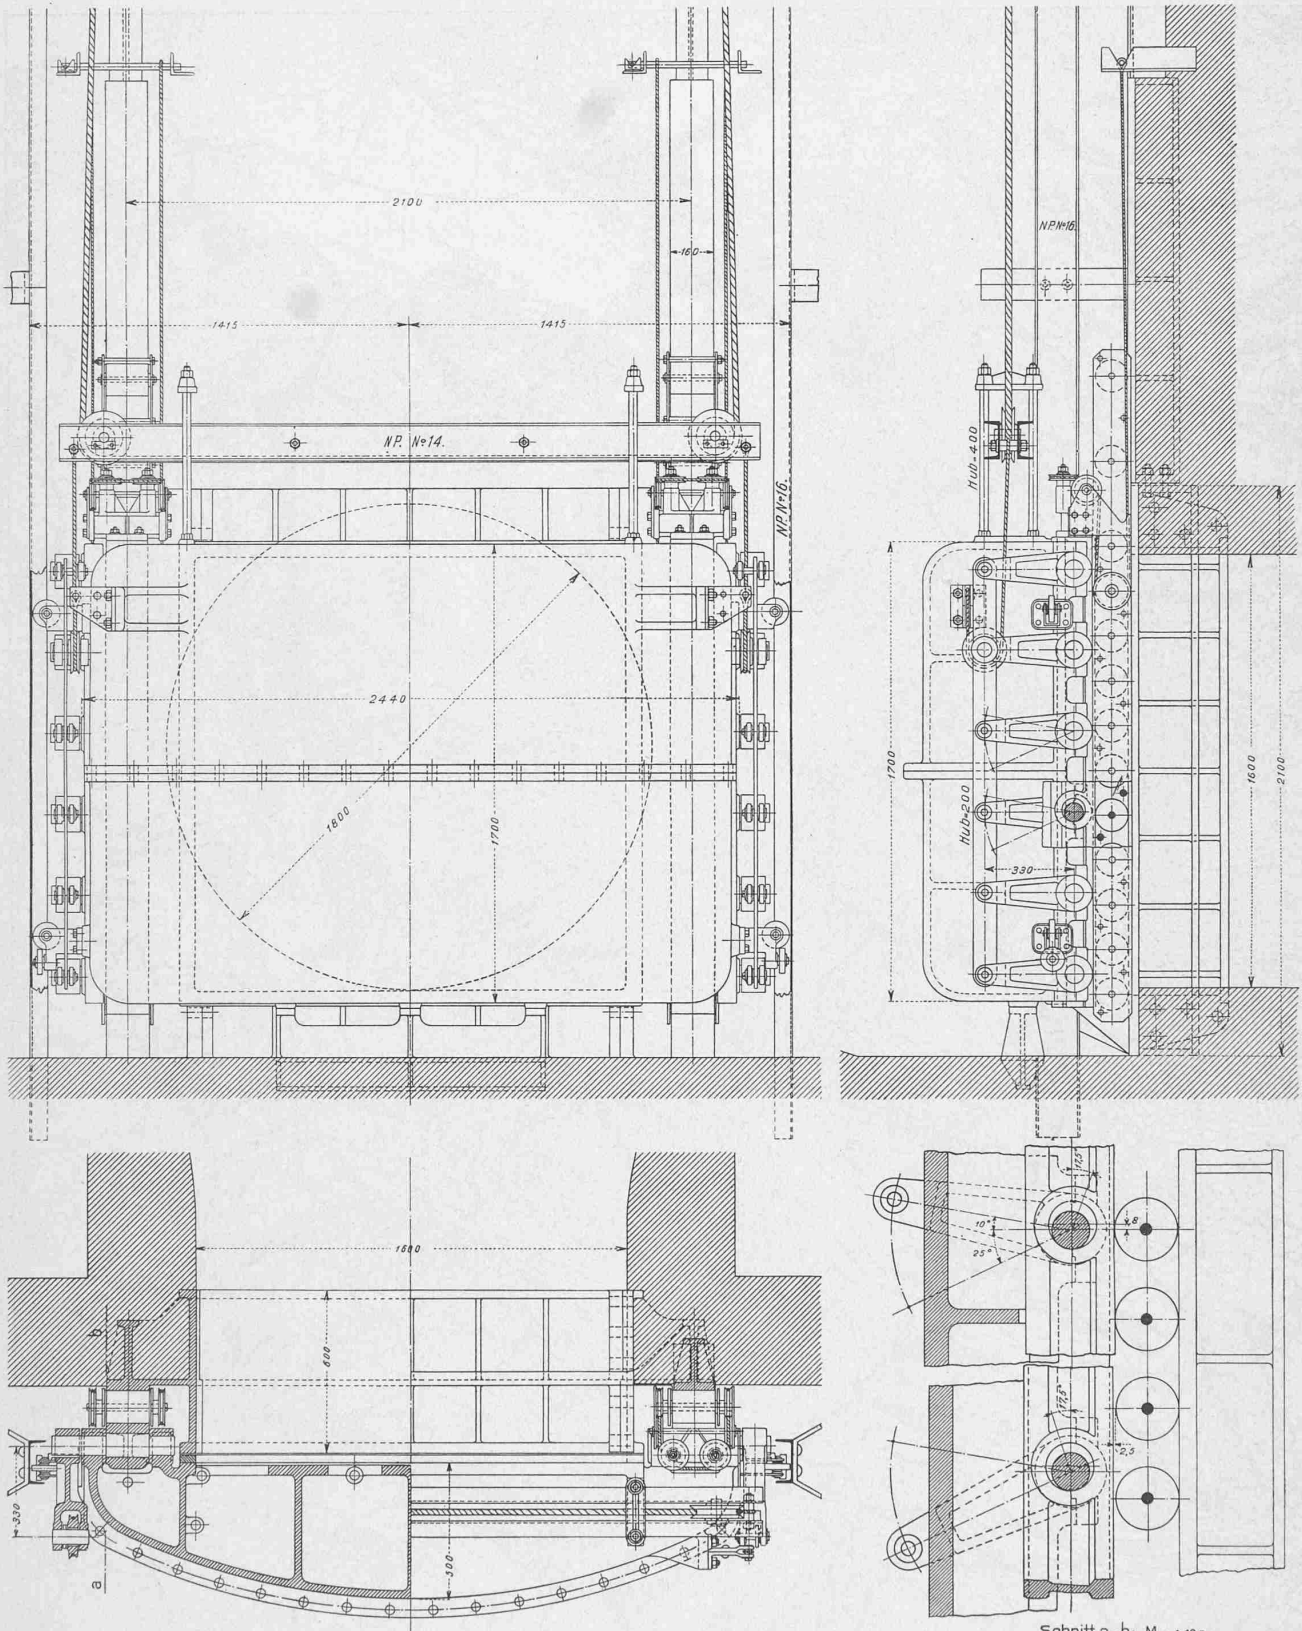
Druckstollen-Abschluss-Schütze, Konstruktion *Escher Wyss & Co.*, Zürich. — Ansicht und Schnitte 1 : 25, Detail 1 : 12,5.
